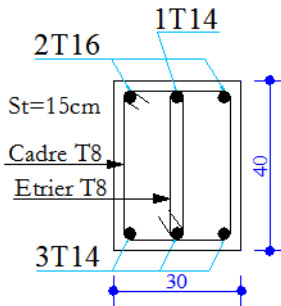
Schéma de ferrailage de la poutre de chaînage
